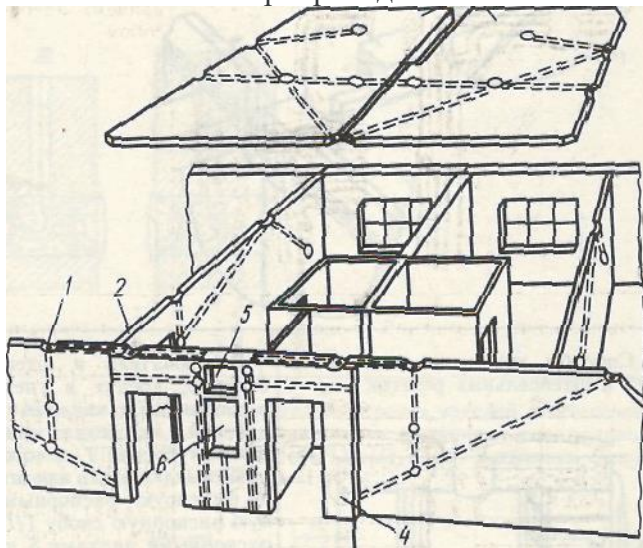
Эскиз скрытой электропроводки расположенной в канале строительной конструкции
